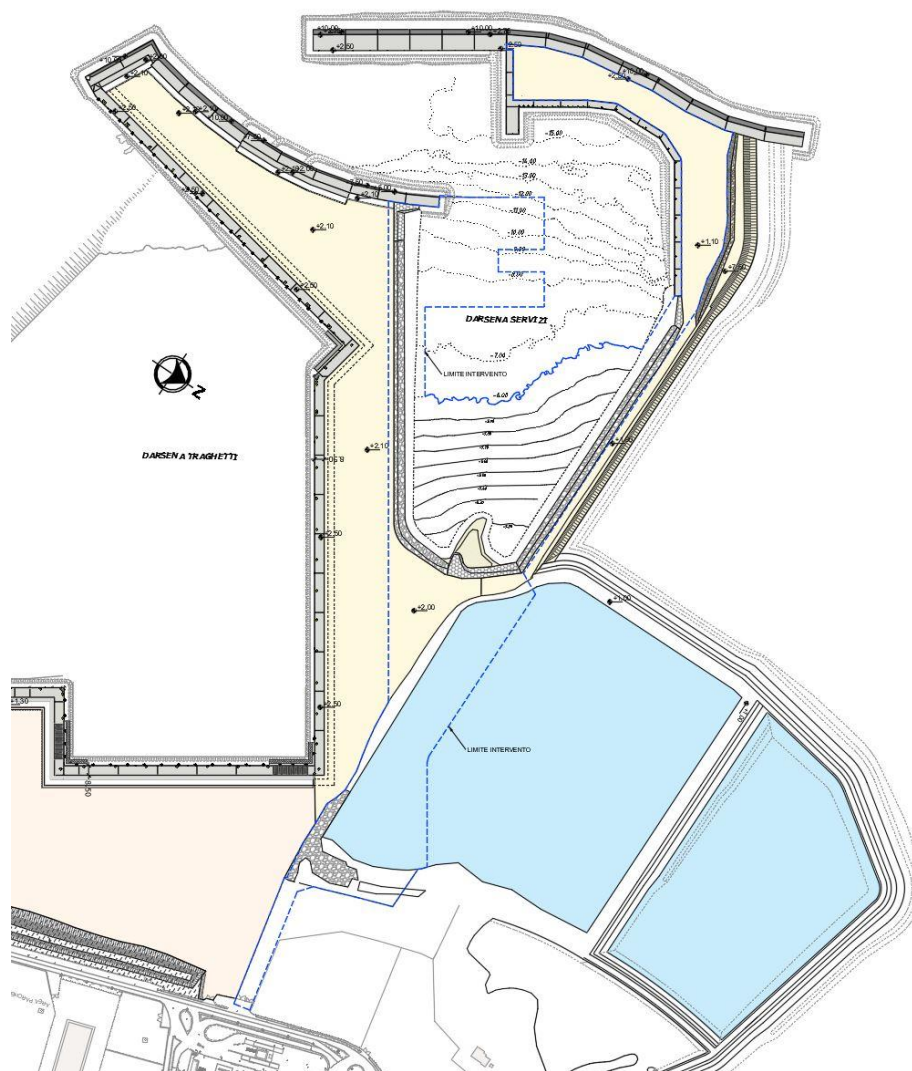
Darsena Servizi: Planimetria dello stato attuale con andamento plano-batimetrico e sagoma dell'intervento
